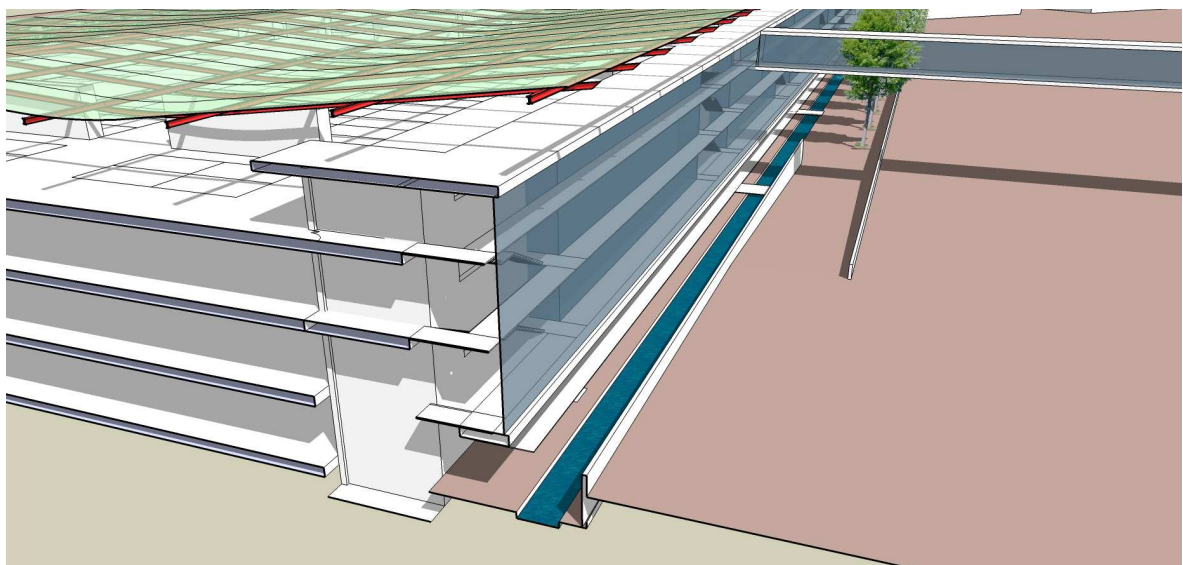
sezione trasversale dimensionale del park B1 con collegamento pedonale al Moving Walkway
